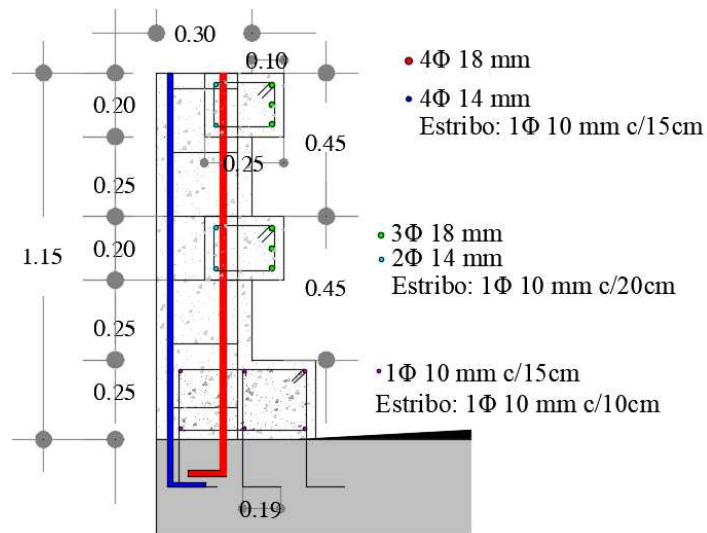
Diseño final de la protección lateral de hormigón armado (poste - viga)
